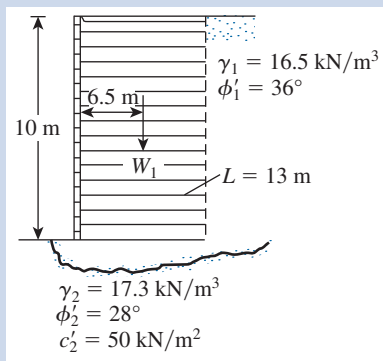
Muro de retención con refuerzo de tiras de acero galvanizado en el relleno.
